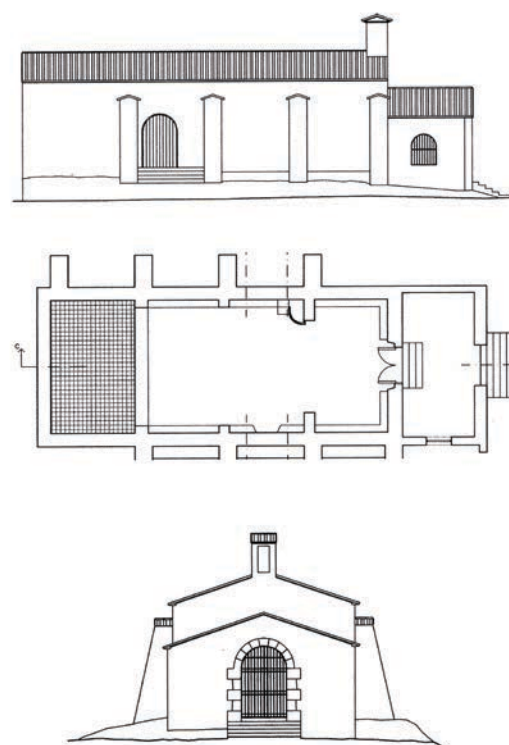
Planta y alzados de la Ermita de Santa Bárbara de Cocentaina (Fuente: Domenech Faus, 2003).
